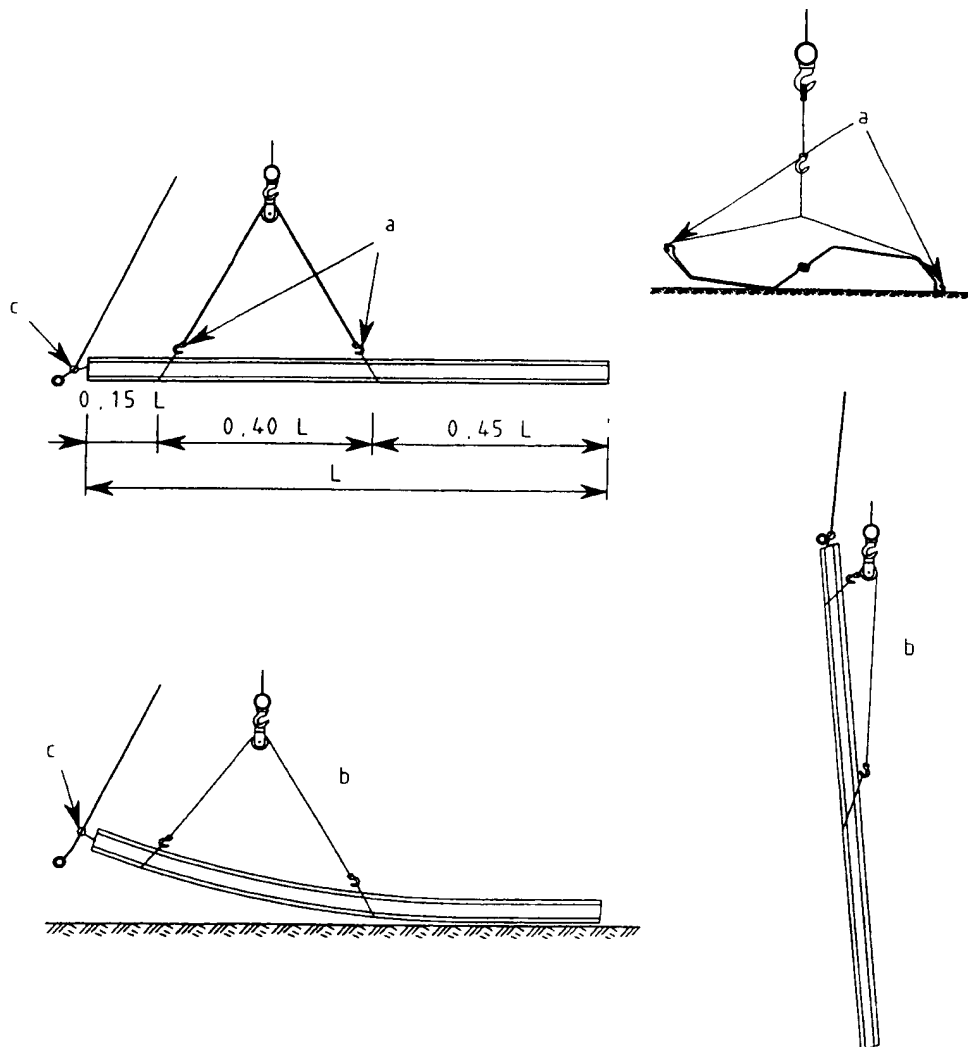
Izado de tablestacas sin ayuda de viga
